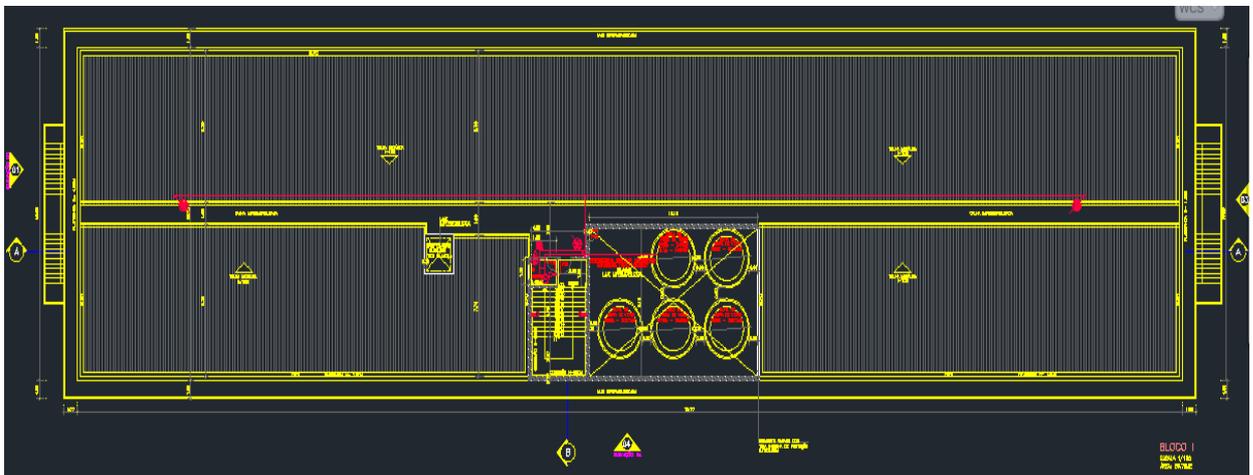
Planta de cobertura do bloco 1 da faculdade Multivix Serra.
